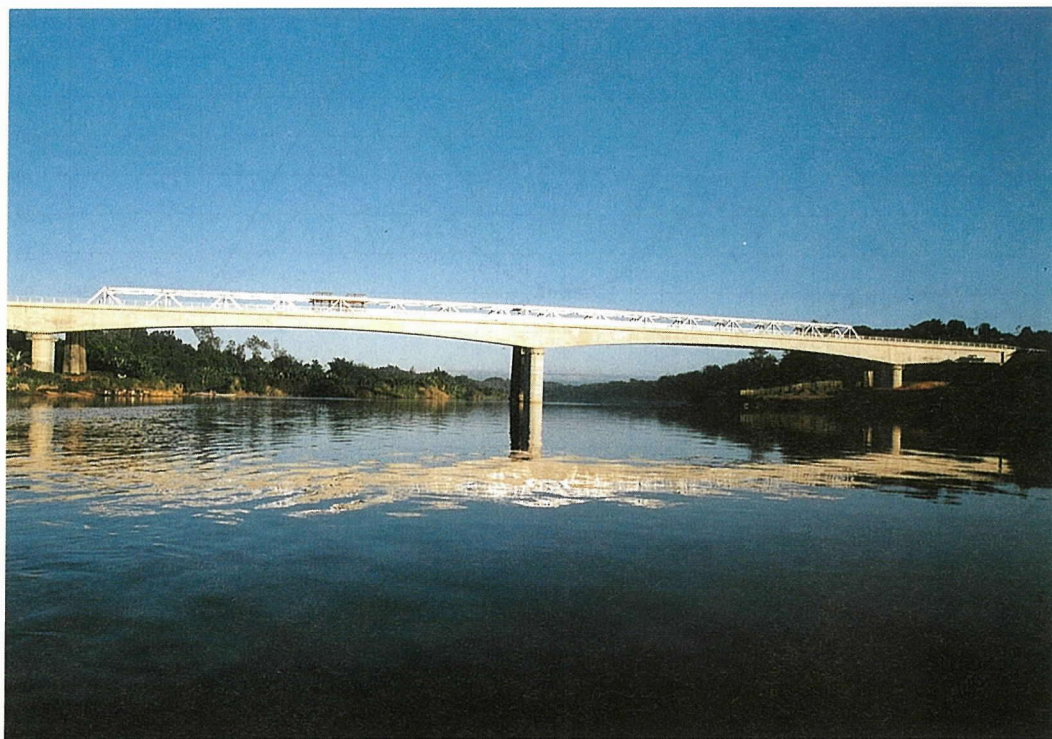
完成した新橋(PC 4 径間連続箱桁橋)および補修された旧橋(鋼 2 径間連続トラス橋)
